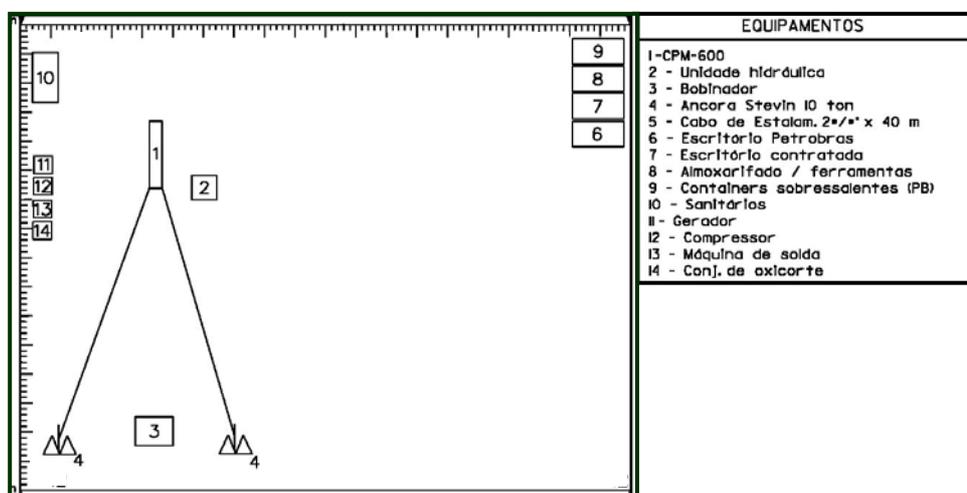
Desenho esquemático da Base de Guincho semelhante a ser utilizada
